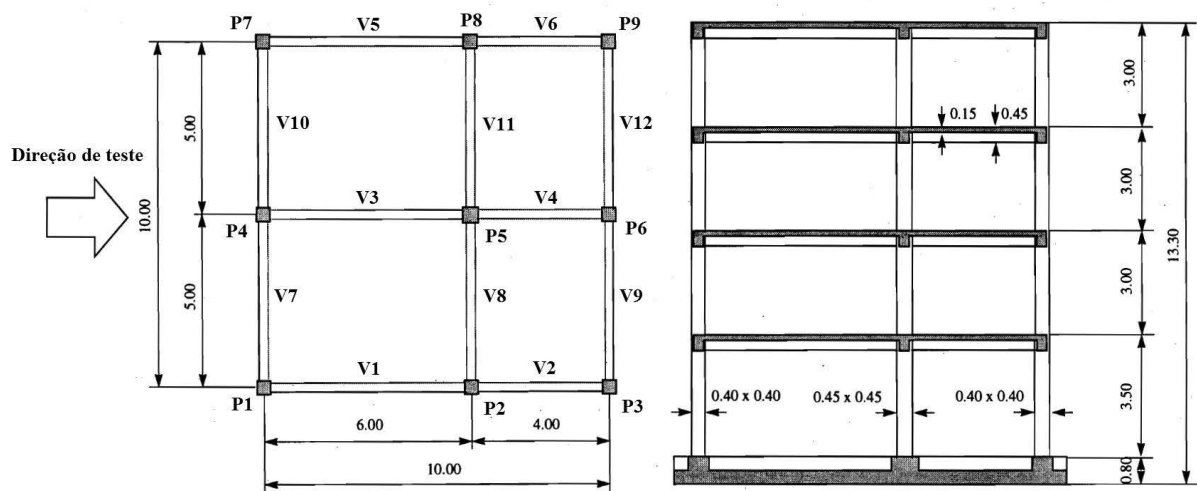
Planta e alçado do edifício em estudo (adaptado de Negro et al. (1994)).
